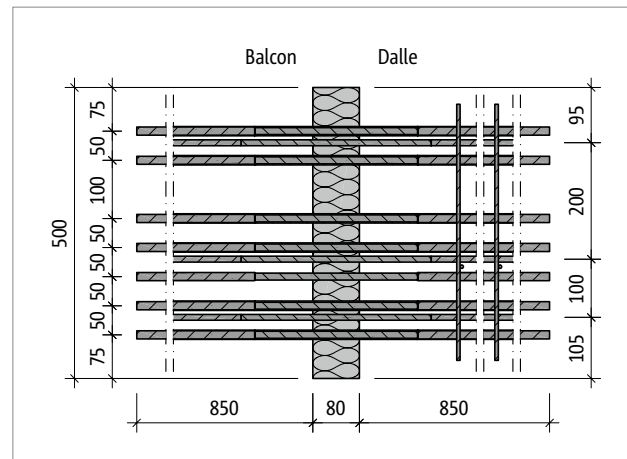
Schöck Isokorb® T Type K-M13-V1 : Plan de base du produit
